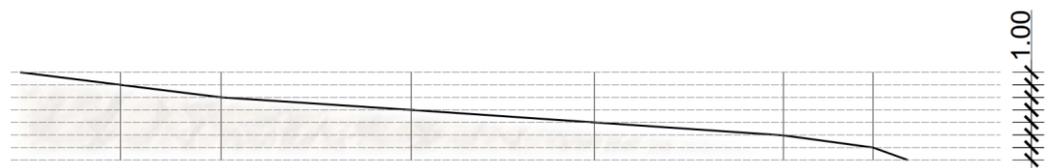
Sección B – B. Fuente: Elaboración Propia
